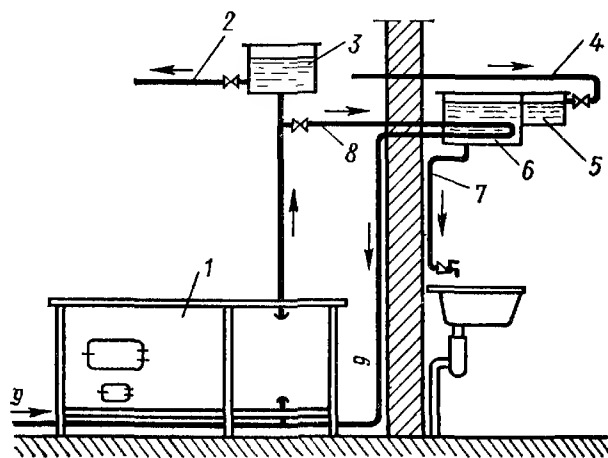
Горячее водоснабжение, совмещенное с квартирным отоплением:
